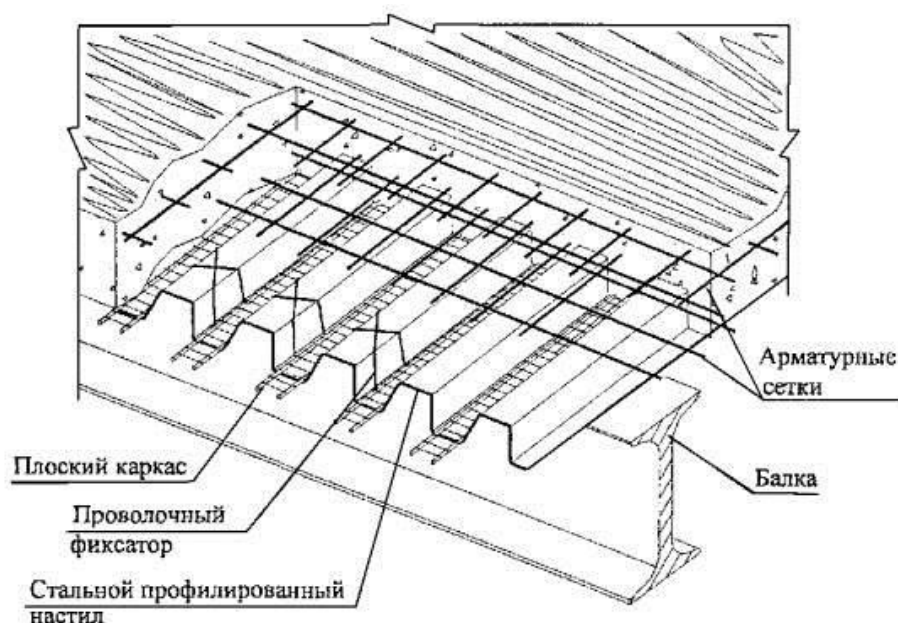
Конструкция монолитного перекрытия с применением стального профилированного настила в качестве несъемной опалубки
